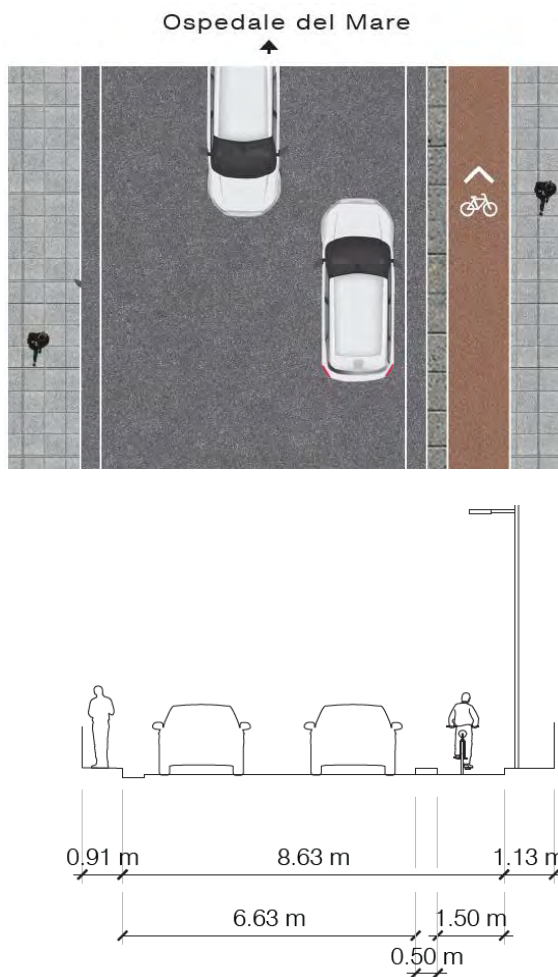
Sezione trasversale e pianta di progetto Via Ponte Cavalcavia Ponticelli
